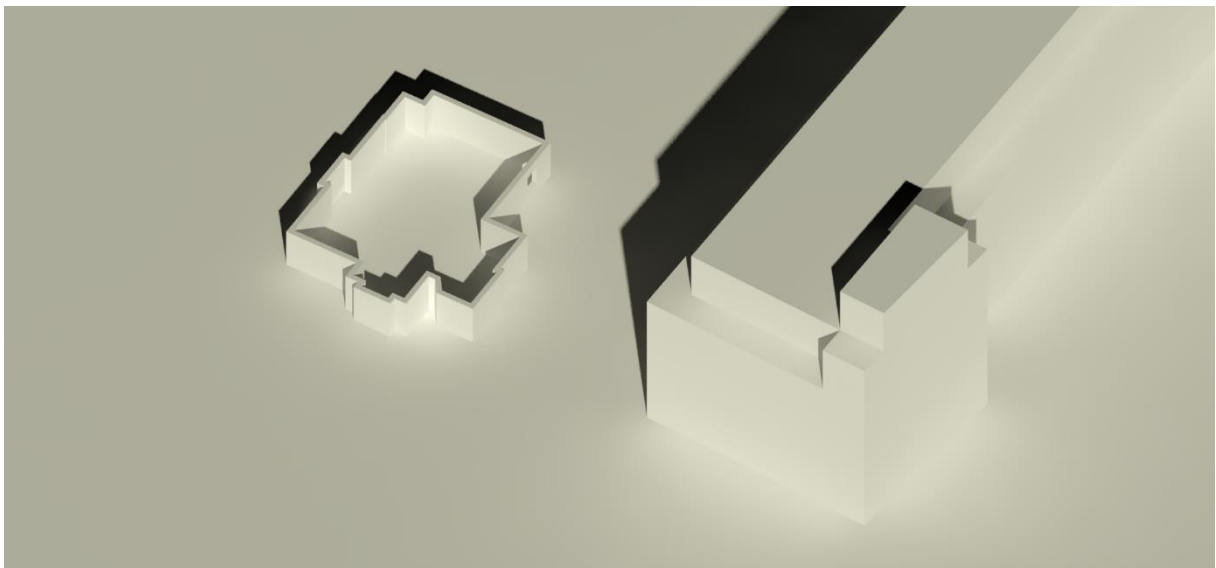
Untersuchungsobjekt (teilweise) mit möglichem Baukörper gemäß Bebauungsplan-Entwurf Sülldorf 23/Iserbrook 27 (teilweise); eigene Abbildung
